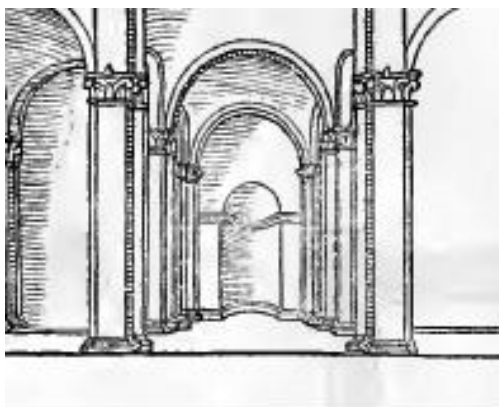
Orden Corintio, en pilastras exteriores en el tratado de Pietro Catáneo
